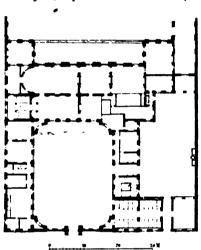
Hôtel de Lyonne zu Paris. Grundriss des Erdgeschosses.
